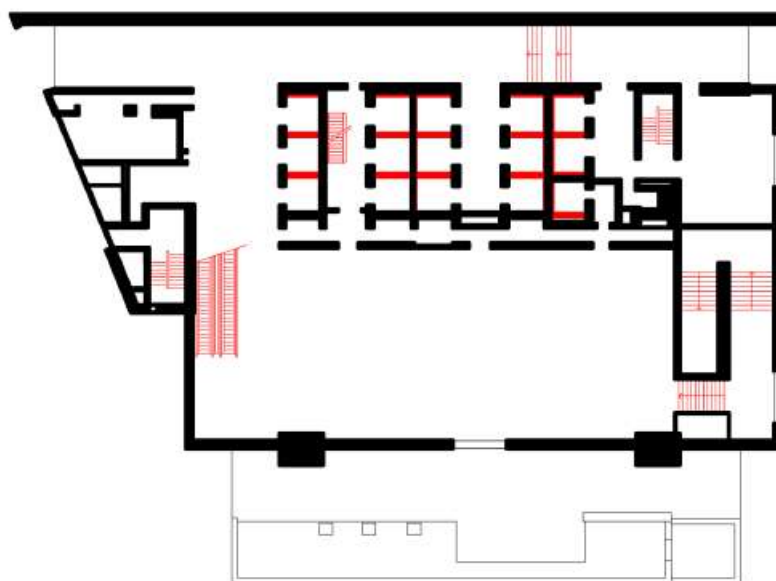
Henrique Mindlin. Edifício BEG. Planta do Pavimento Tipo.
